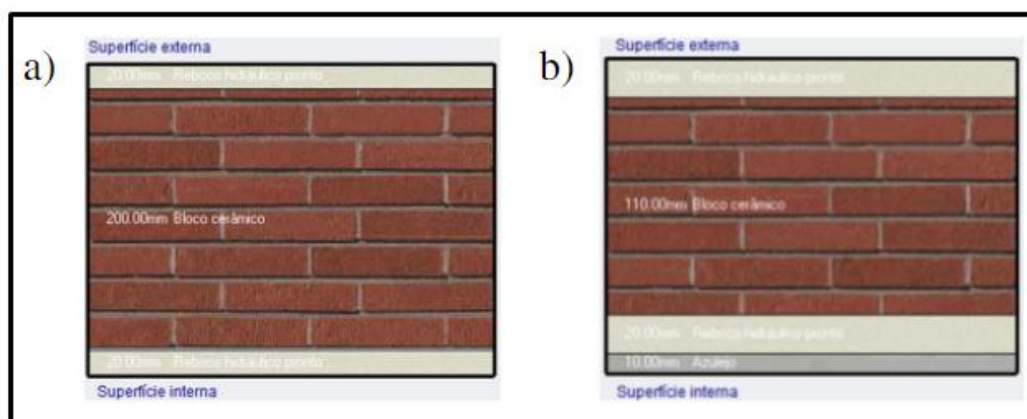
Pormenores construtivos das paredes internas: a) Parede interna tipo I1; b) Parede interna tipo I2
